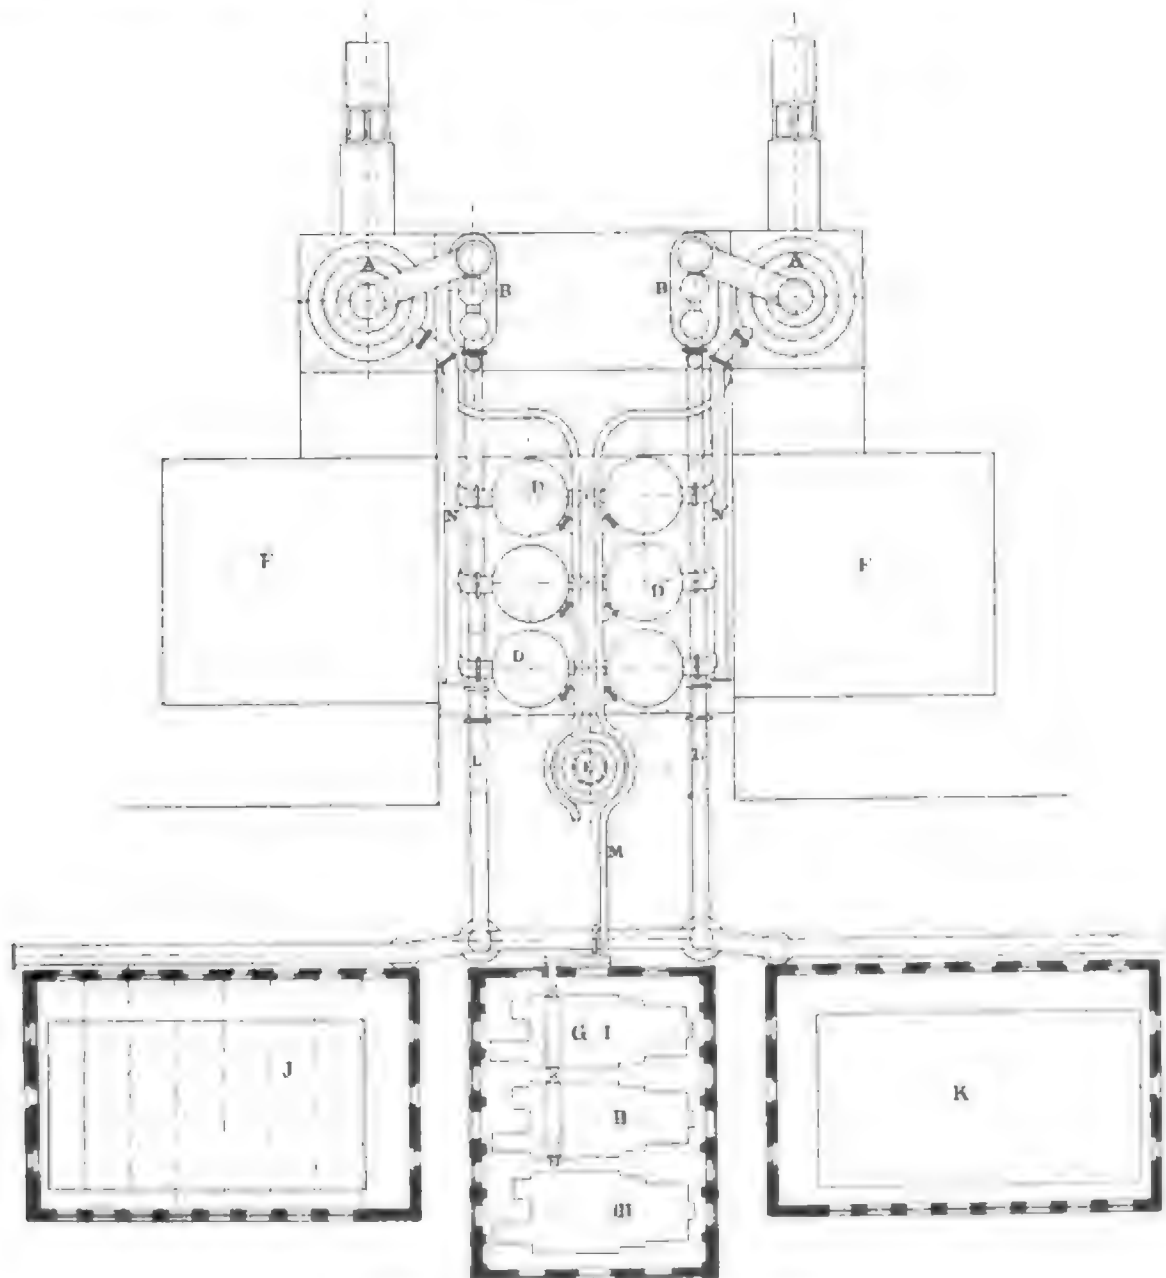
Lageplan der Donezko-Jurjewski-Hütte.
